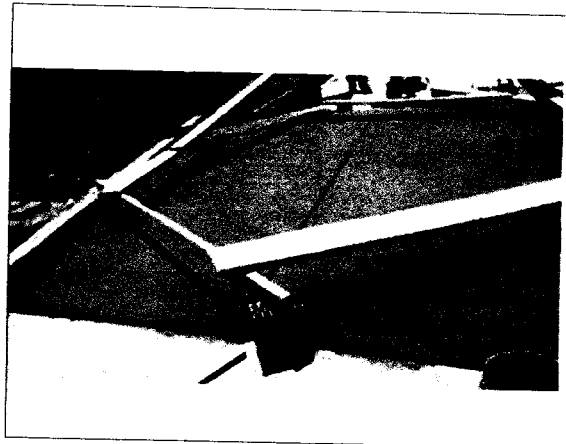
COLOCADO DE CONCRETO PARA VEREDAS
